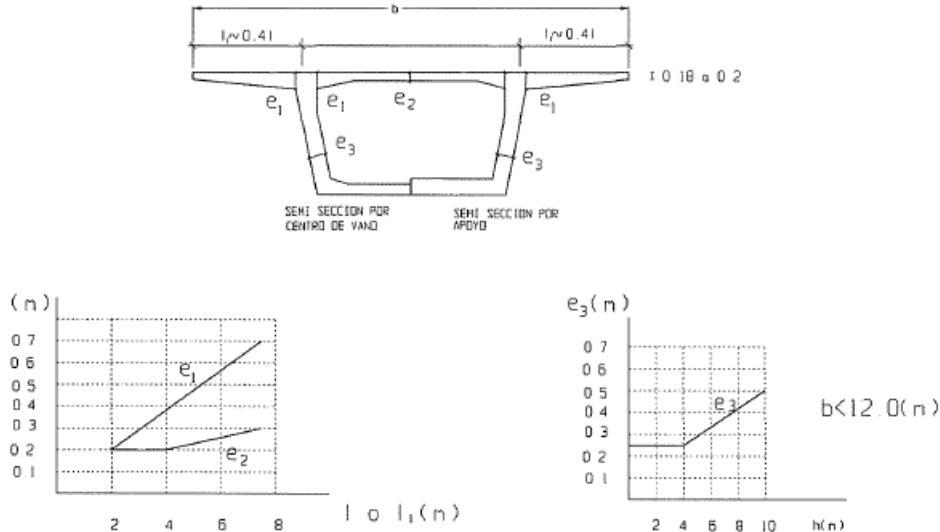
Predimensionamiento sección en cajón. Fuente [1]
